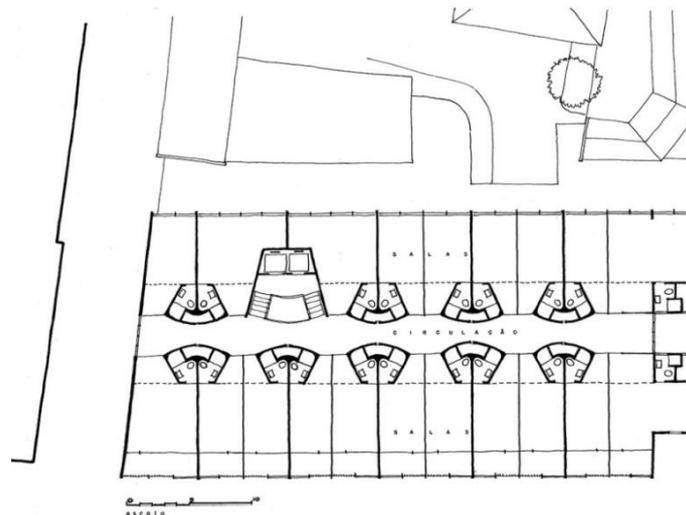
Planta Baixa Pavimento Tipo do Edifício Santo Antônio. Fonte: << <http://acaciogilborsoi.com.br/projetos/anos-60/edificio-santo-antonio/>>>. Acesso em 12. Dez. 2016.
